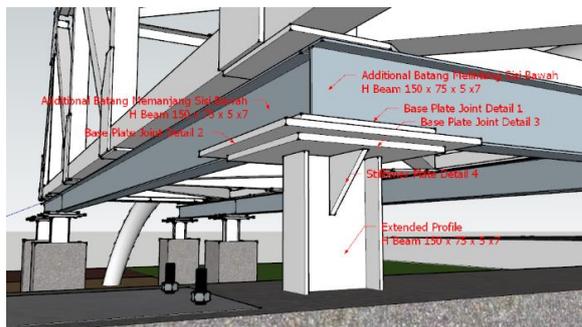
Pengelasan Extend Profile dengan Base plate Joint dan Stiffener plate
